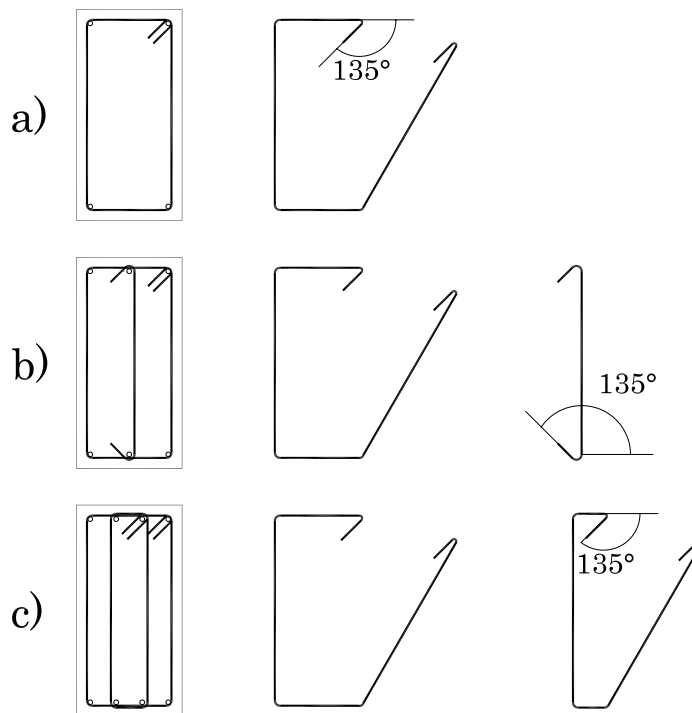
Detalle de armado transversal de vigas, con el doblado de los ganchos a  $135^\circ$
